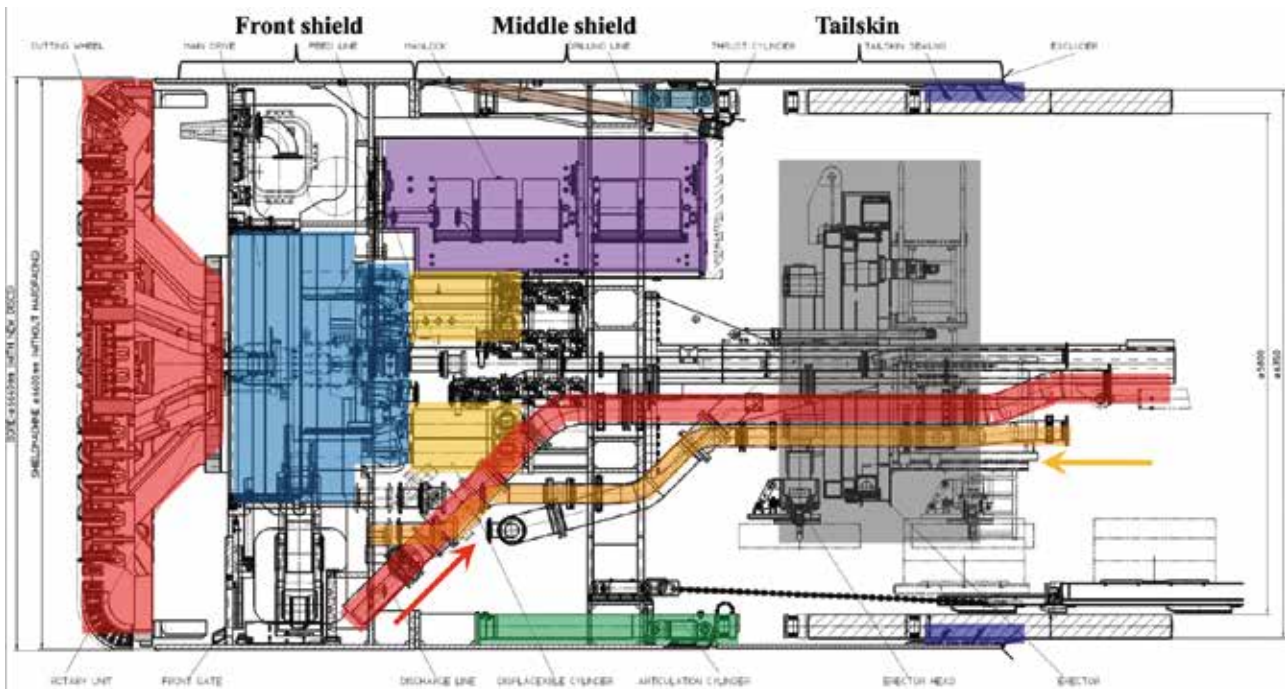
Sección longitudinal tuneladora tipo hidroescudo
